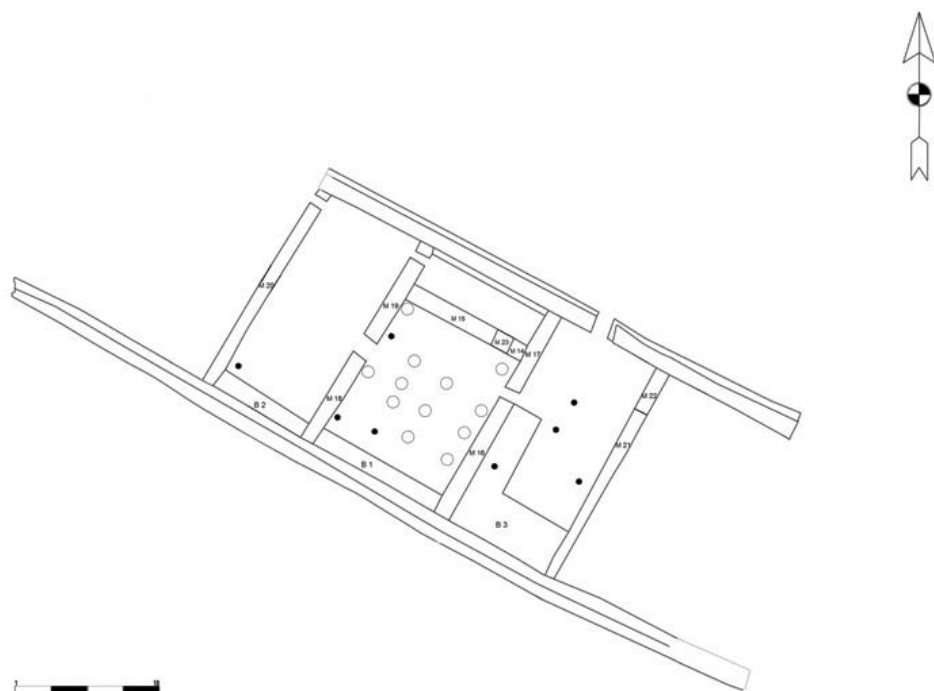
(2).- Fase constructiva 5: planta
